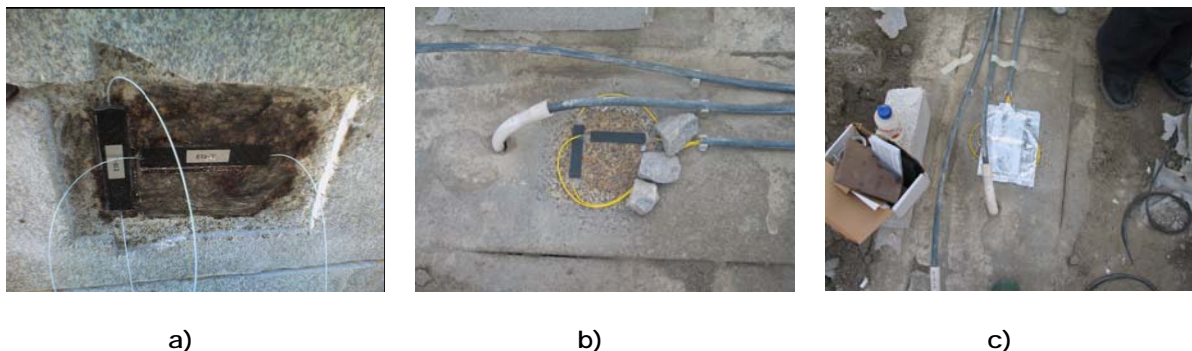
26 – Par de CSG's. a) e b) Instalação c) Protecção
